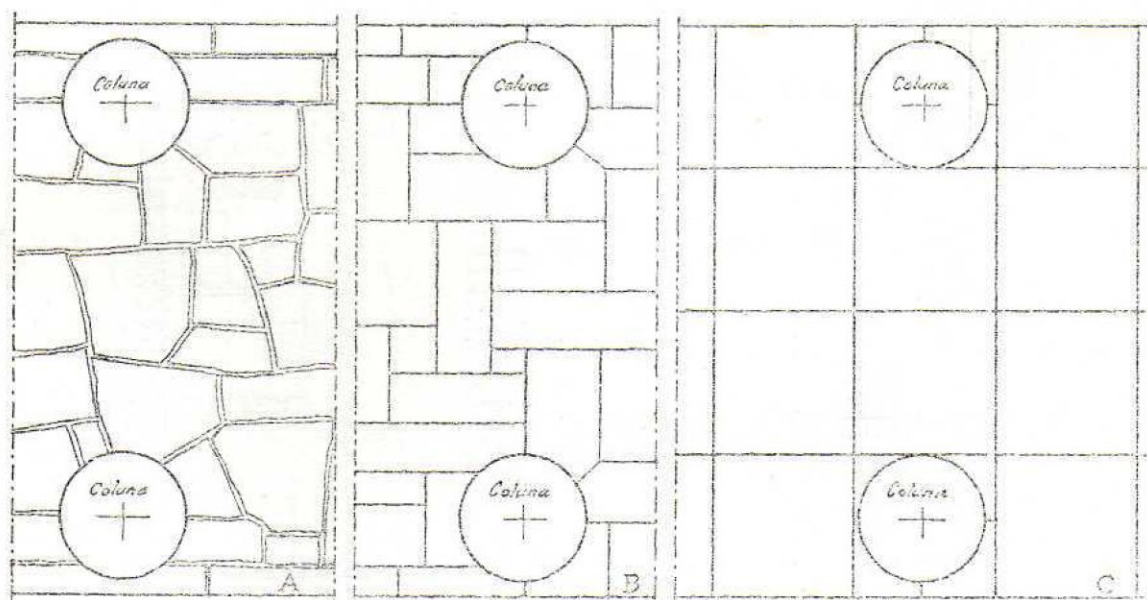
DIVERSOS TIPOS DE PAVIMENTOS LAJEADOS PARA PERGOLAS
